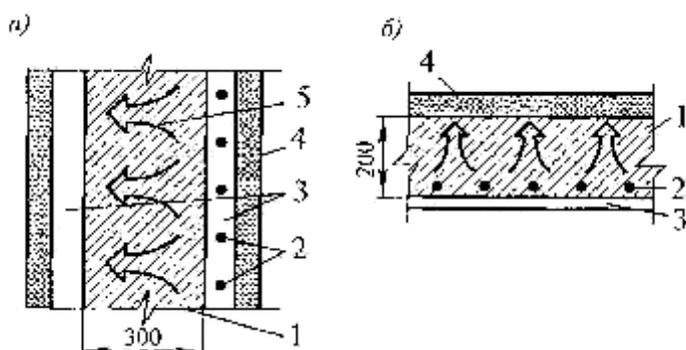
Схемы контактного нагрева монолитных конструкций: а — стены; б — перекрытия; 1 — забетонированная конструкция; 2 — нагревательные элементы (греющие провода); 3 — опалубка; 4 — теплоизоляция; 5 — направление теплового потока
